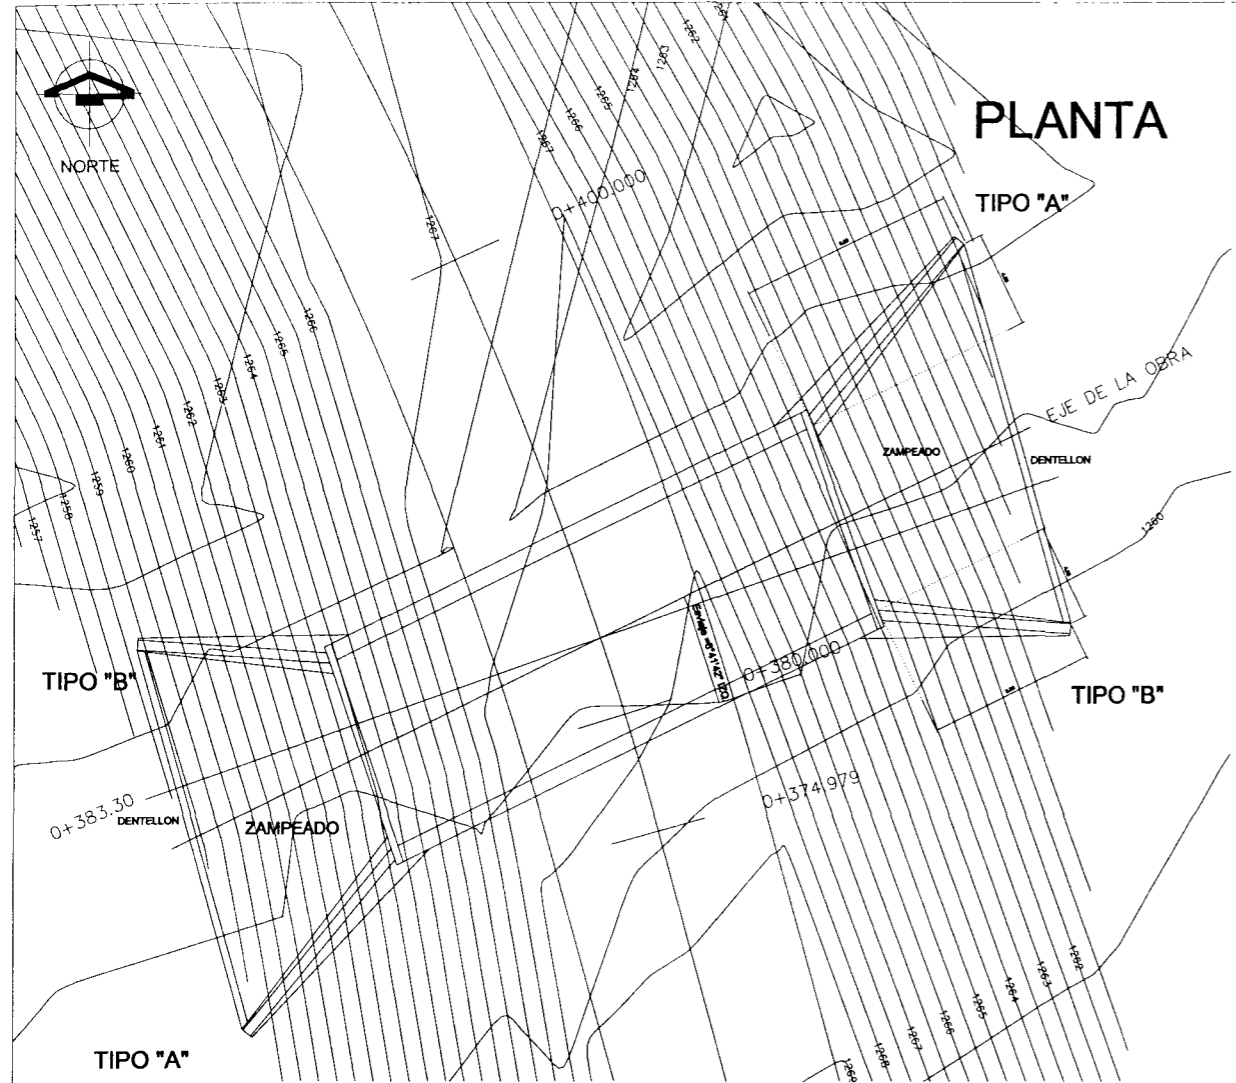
MURO DE MAMPOSTERÍA PARA PASO GANADERO CON TUBOS DE PVC
